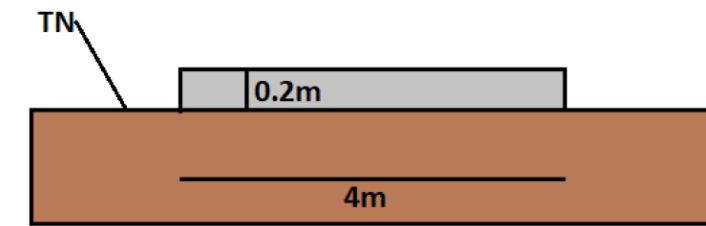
Coupe type voirie piste légère (Source : Photosol)
